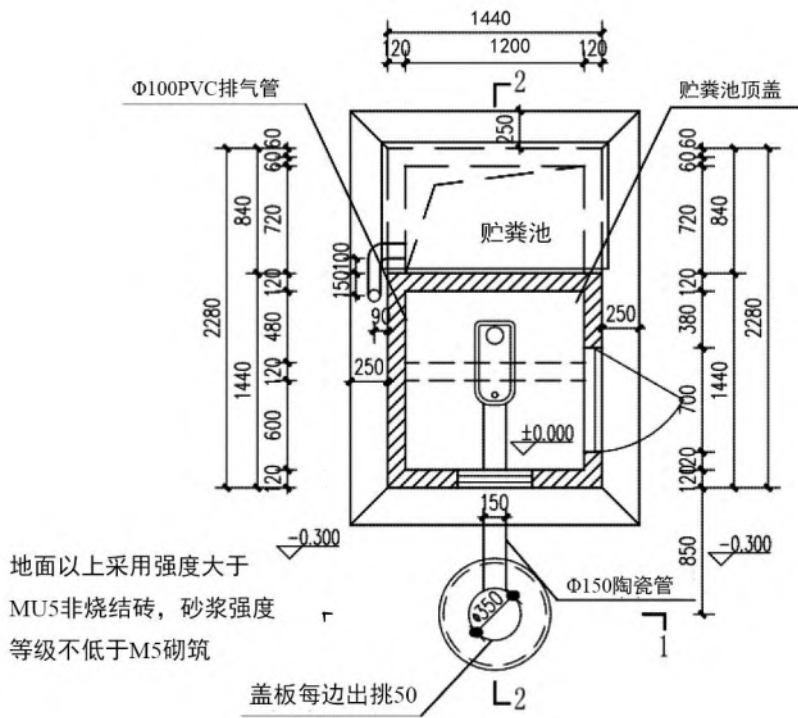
粪尿分集式生态厕所平面图 (尺寸单位: 毫米)
